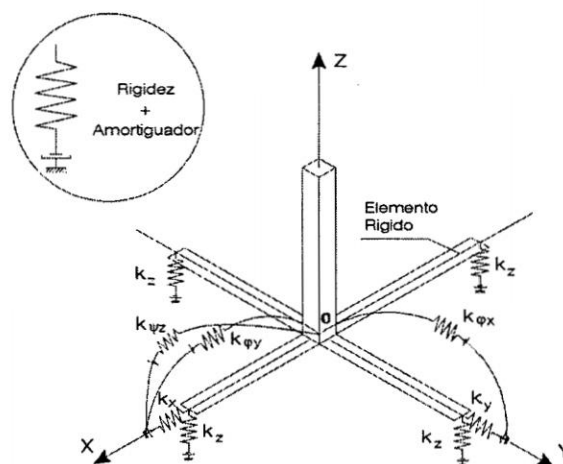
Esquema espacial de Cálculo de la cimentación tipo zapata aislada.
